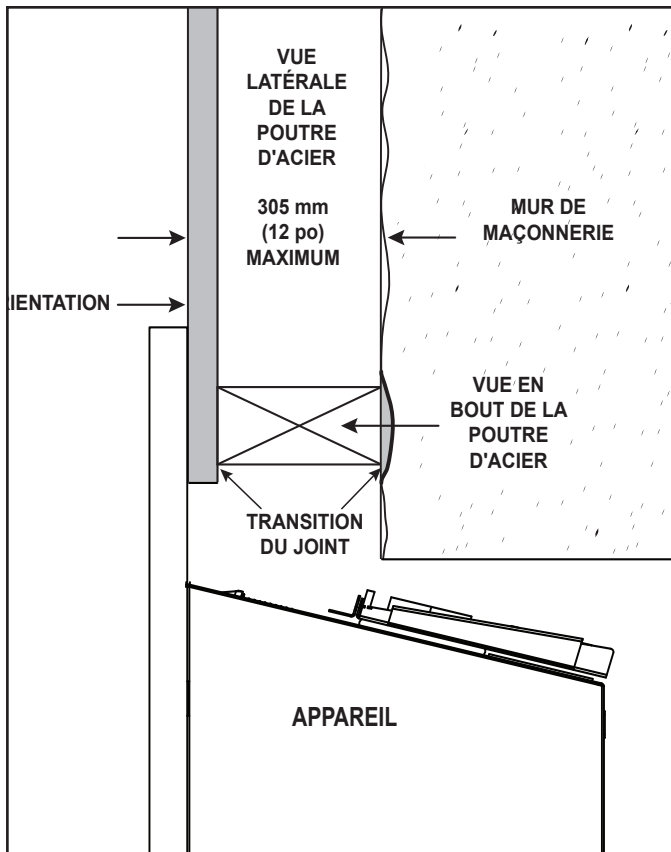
Détails sur l'étanchéité de transition pour les extensions murales (vue latérale)
